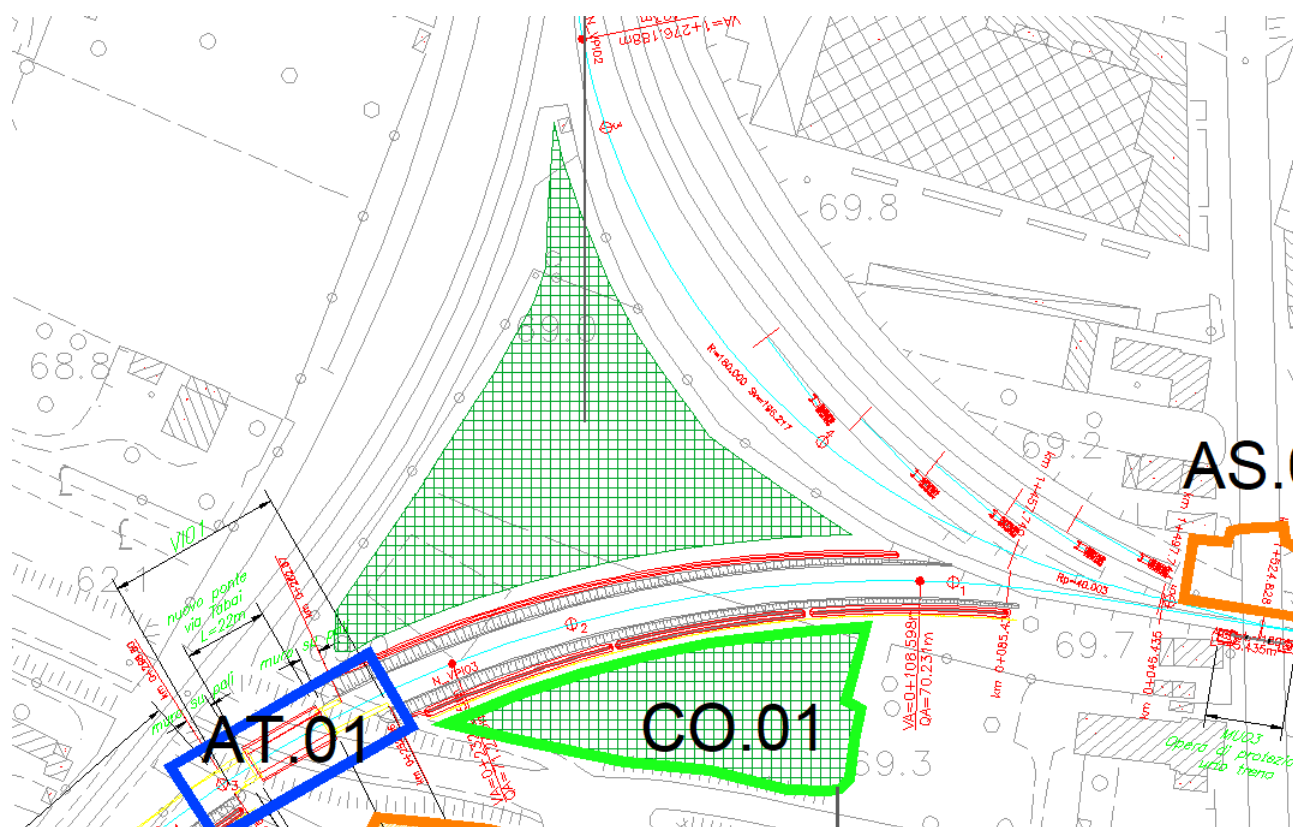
Stralcio planimetrico delle opere a verde a prati stabili
